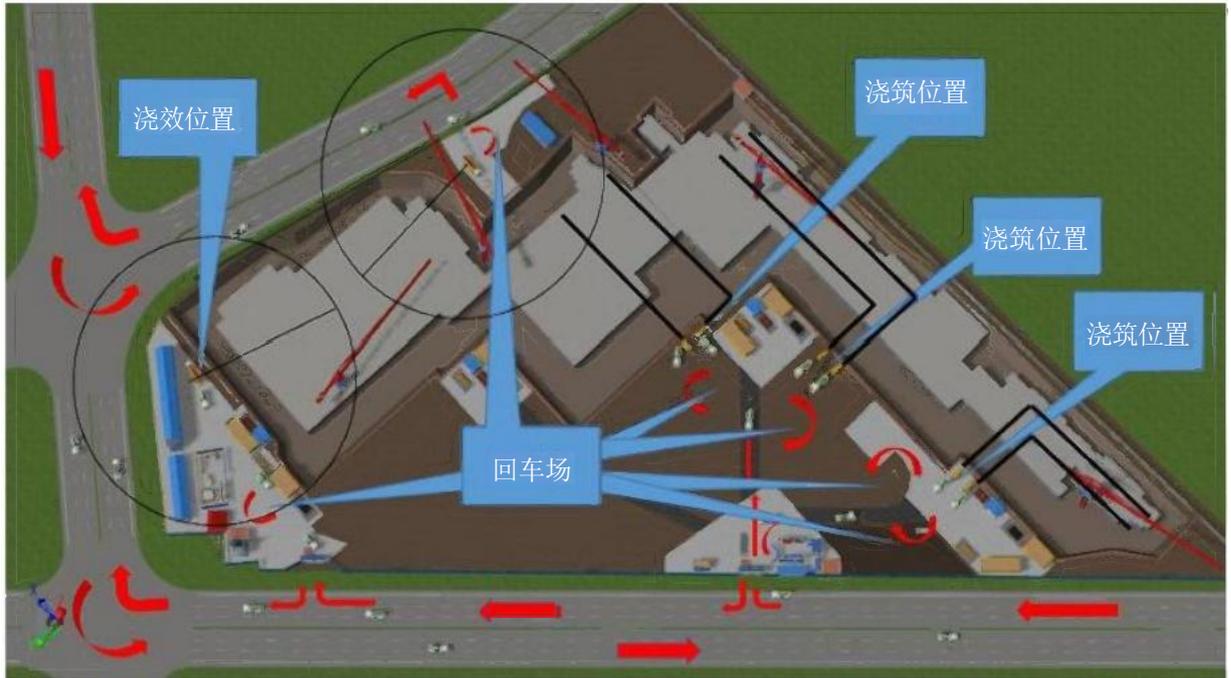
一施工区运输车辆路线、泵管及浇筑位置布置图
